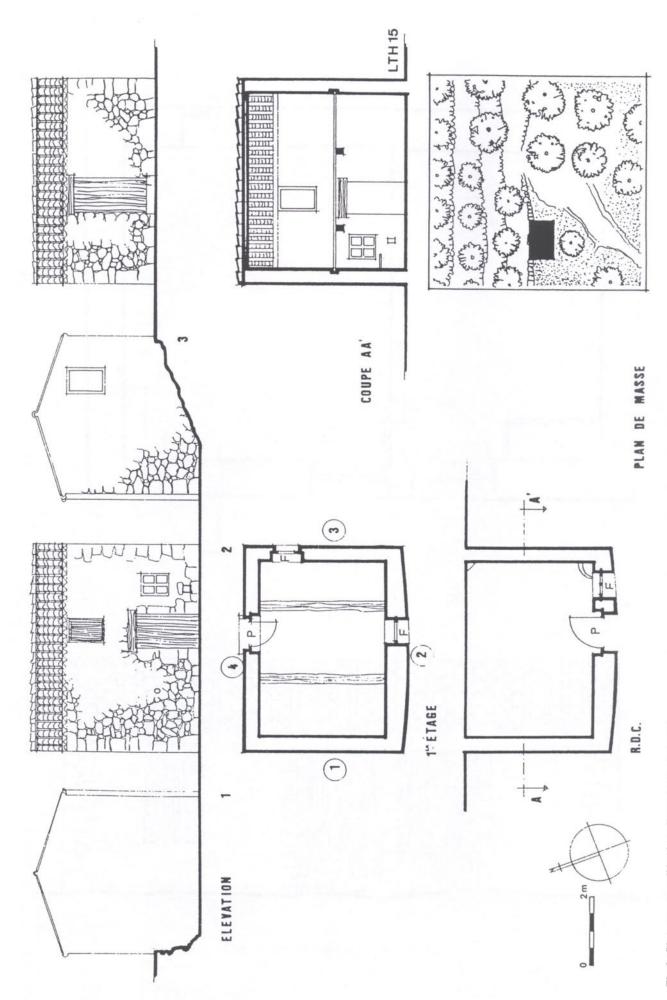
Plan, coupes et élévations d'un cabanon de type 3
